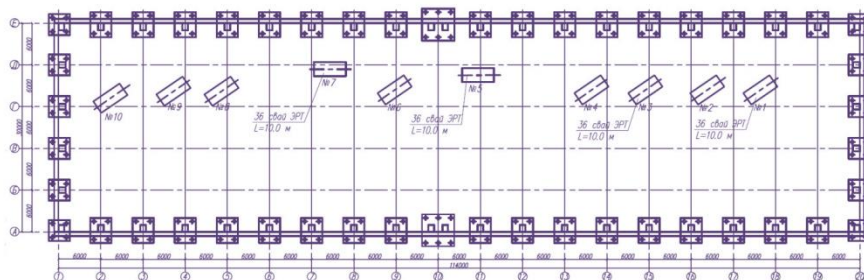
План свайного поля из буронабивных свай ЭРТ
